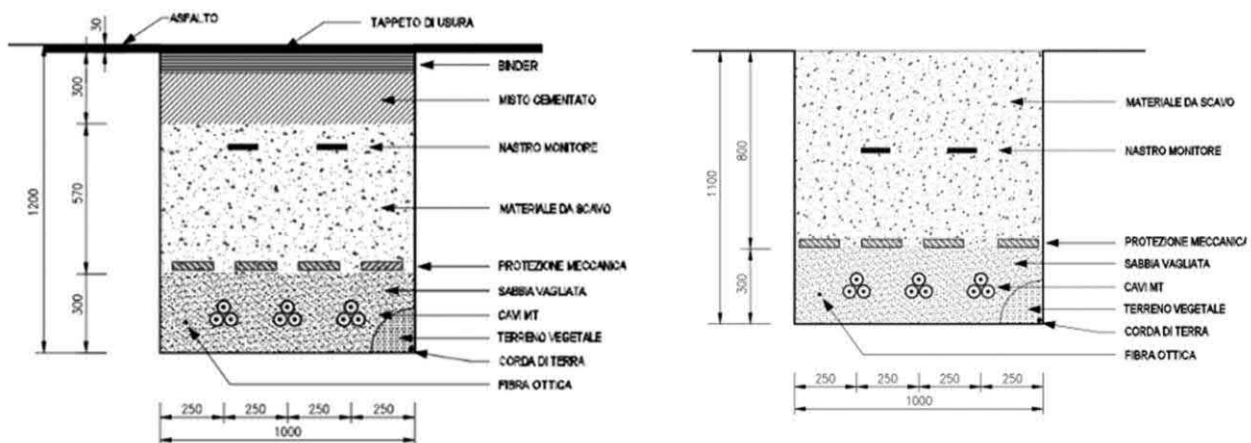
Sezioni tipo cavidotto – su Strada e su Terreno
